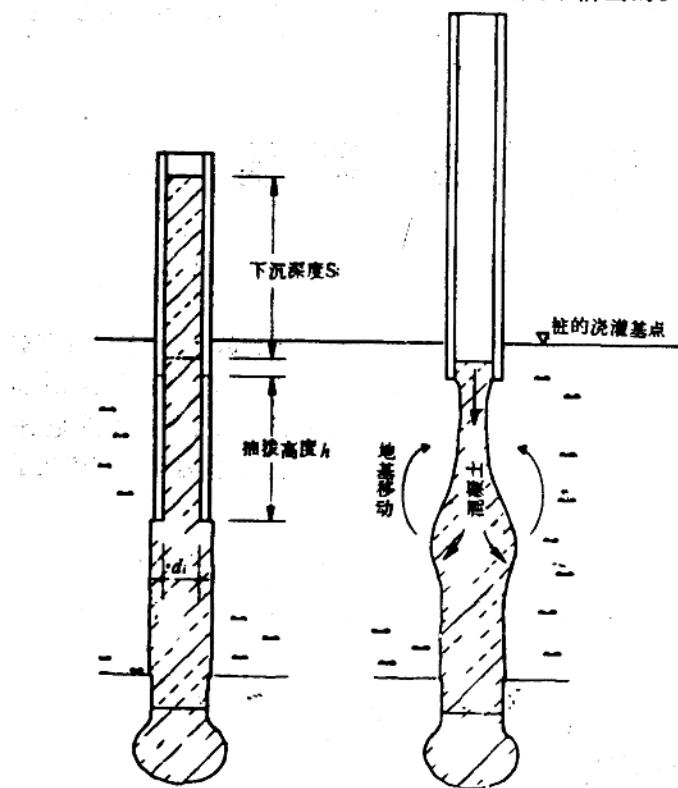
由上部桩内混凝土的沉降及软基产生的土压
